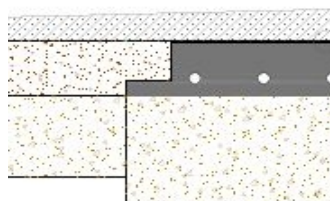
Pavimentazione rigida al centro a flessibile ai lati
